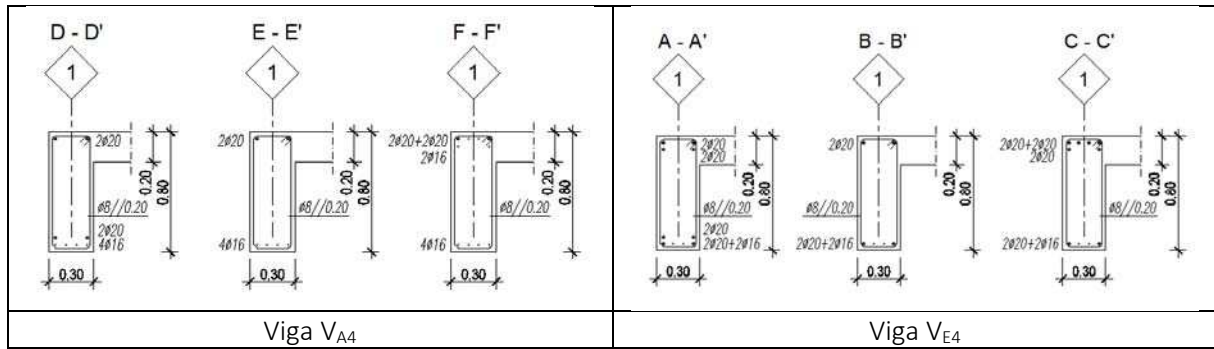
Secções tipo das vigas de bordadura da Torre Poente
